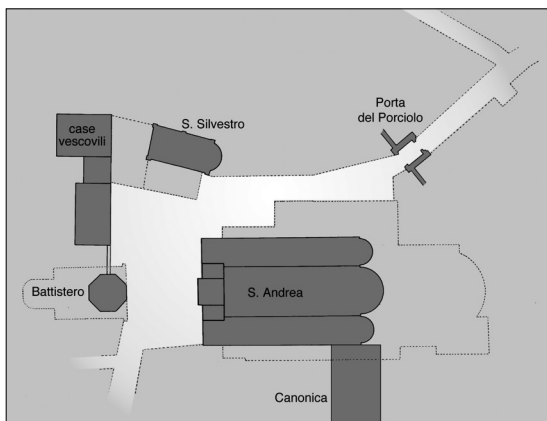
Planimetria dell'area sacra con riportati gli edifici medievali, a tratteggio il perimetro attuale.
